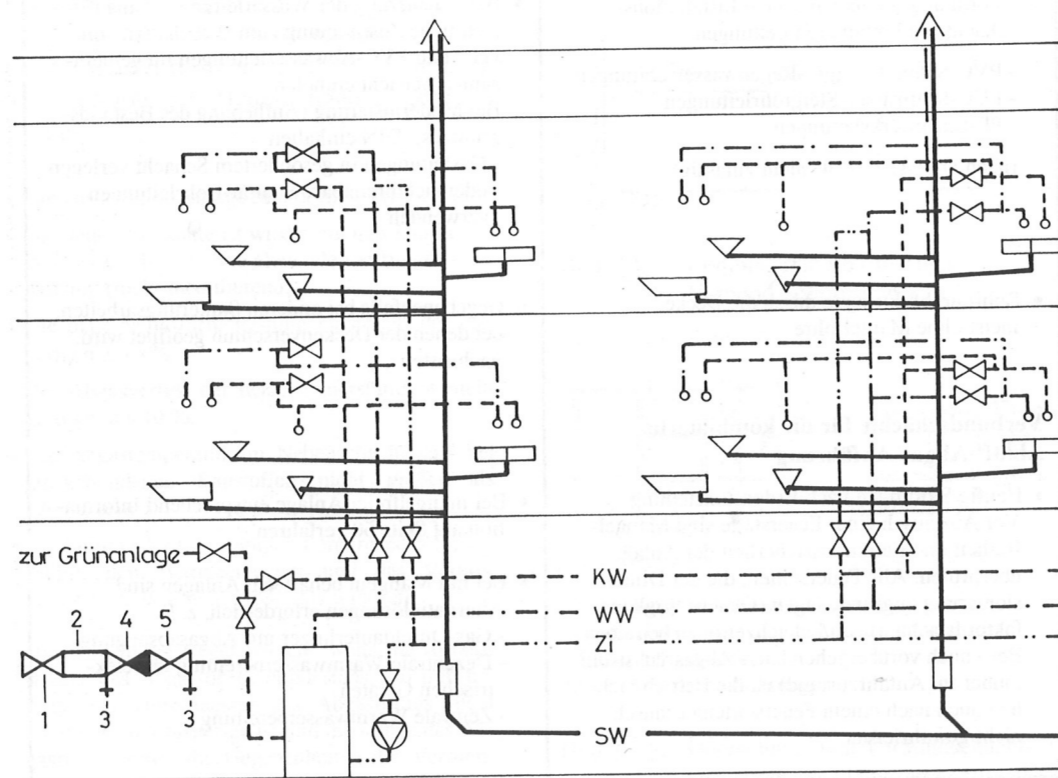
Schema einer Trink- und Abwasserinstallation
